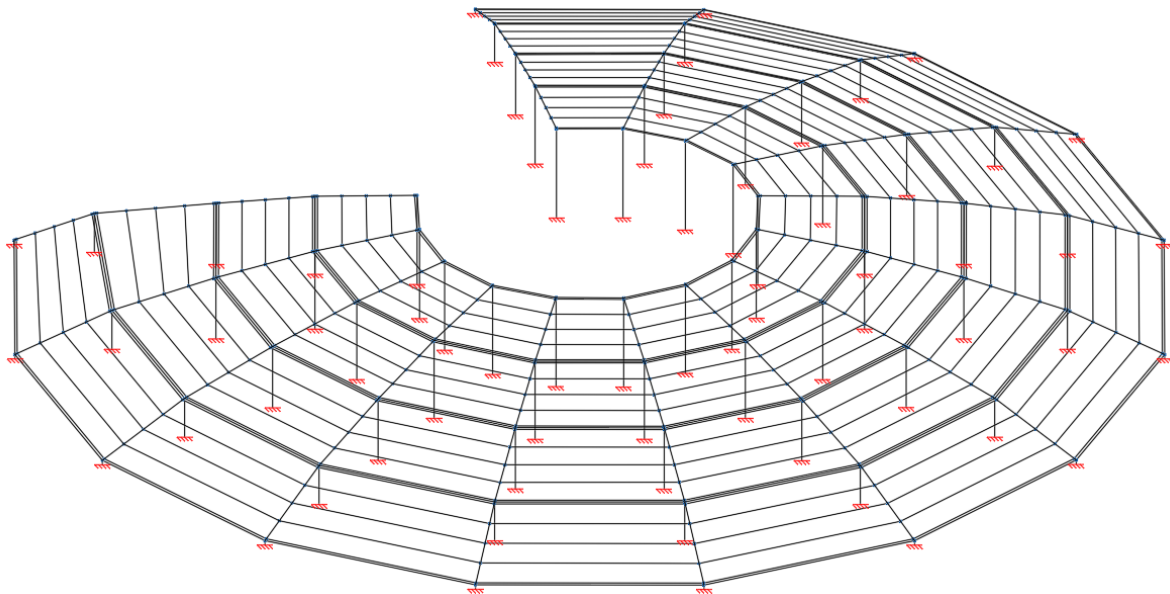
Vista 3D de la estructura metálica de la cúpula.
